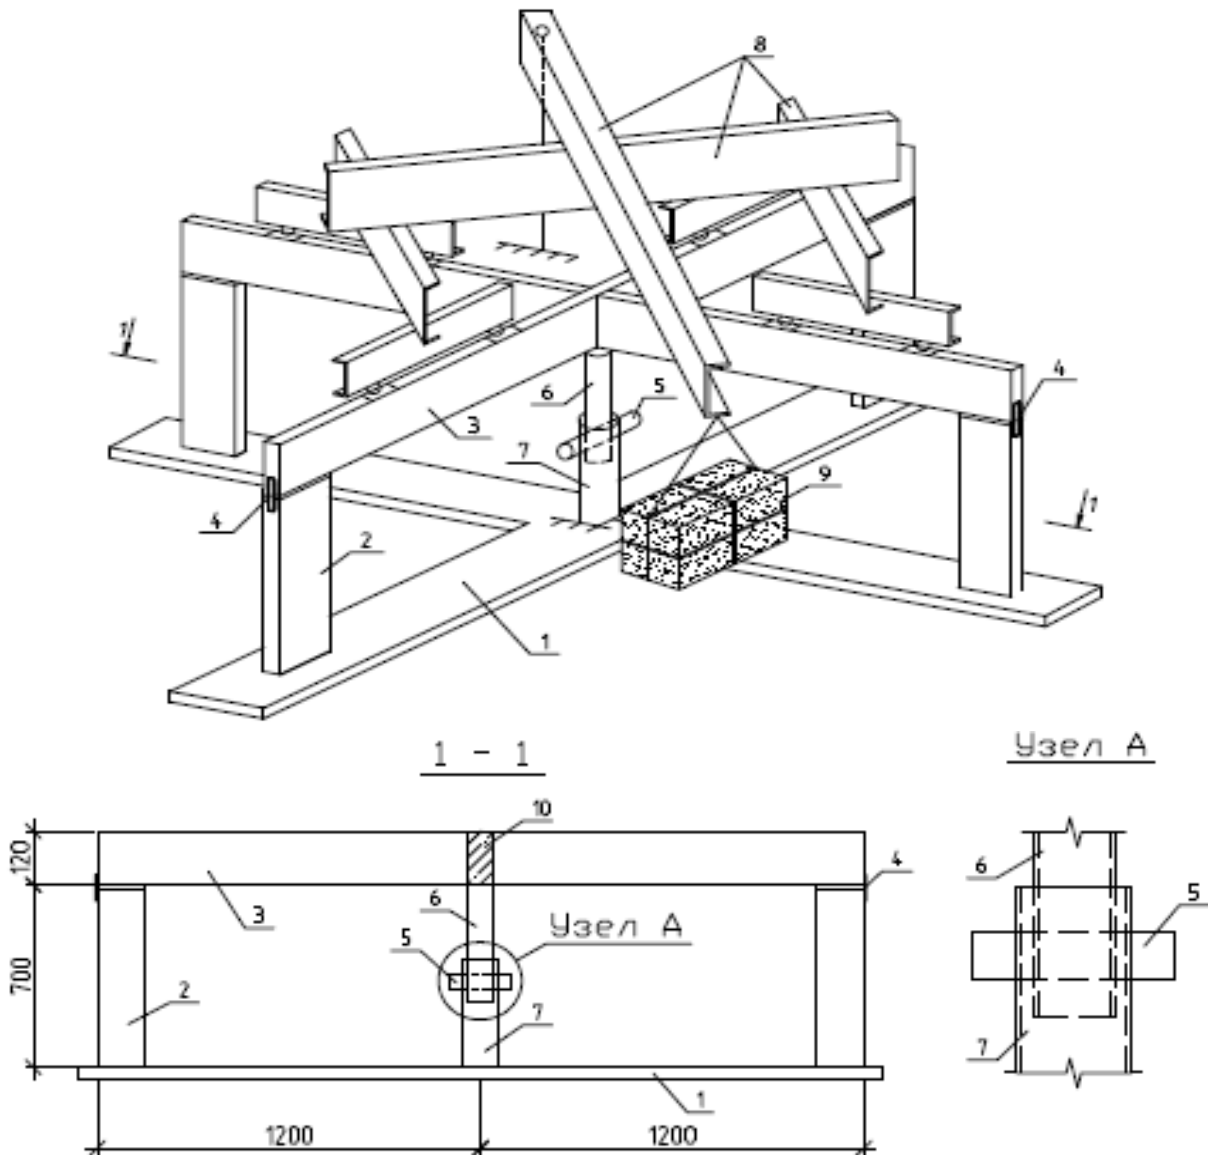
Схема фрагмента пространственной конструктивной системы и нагрузочных устройств: 1 – опорная балка; 2 – стойки; 3 – ригель; 4 – закладные соединительные элементы; 5 – бетонная шпонка; 6, 7 – телескопическая конструкция из двух металлических труб; 8 – рычажная система; 9 – грузовая платформа; 10 – бетон замоноличивания
